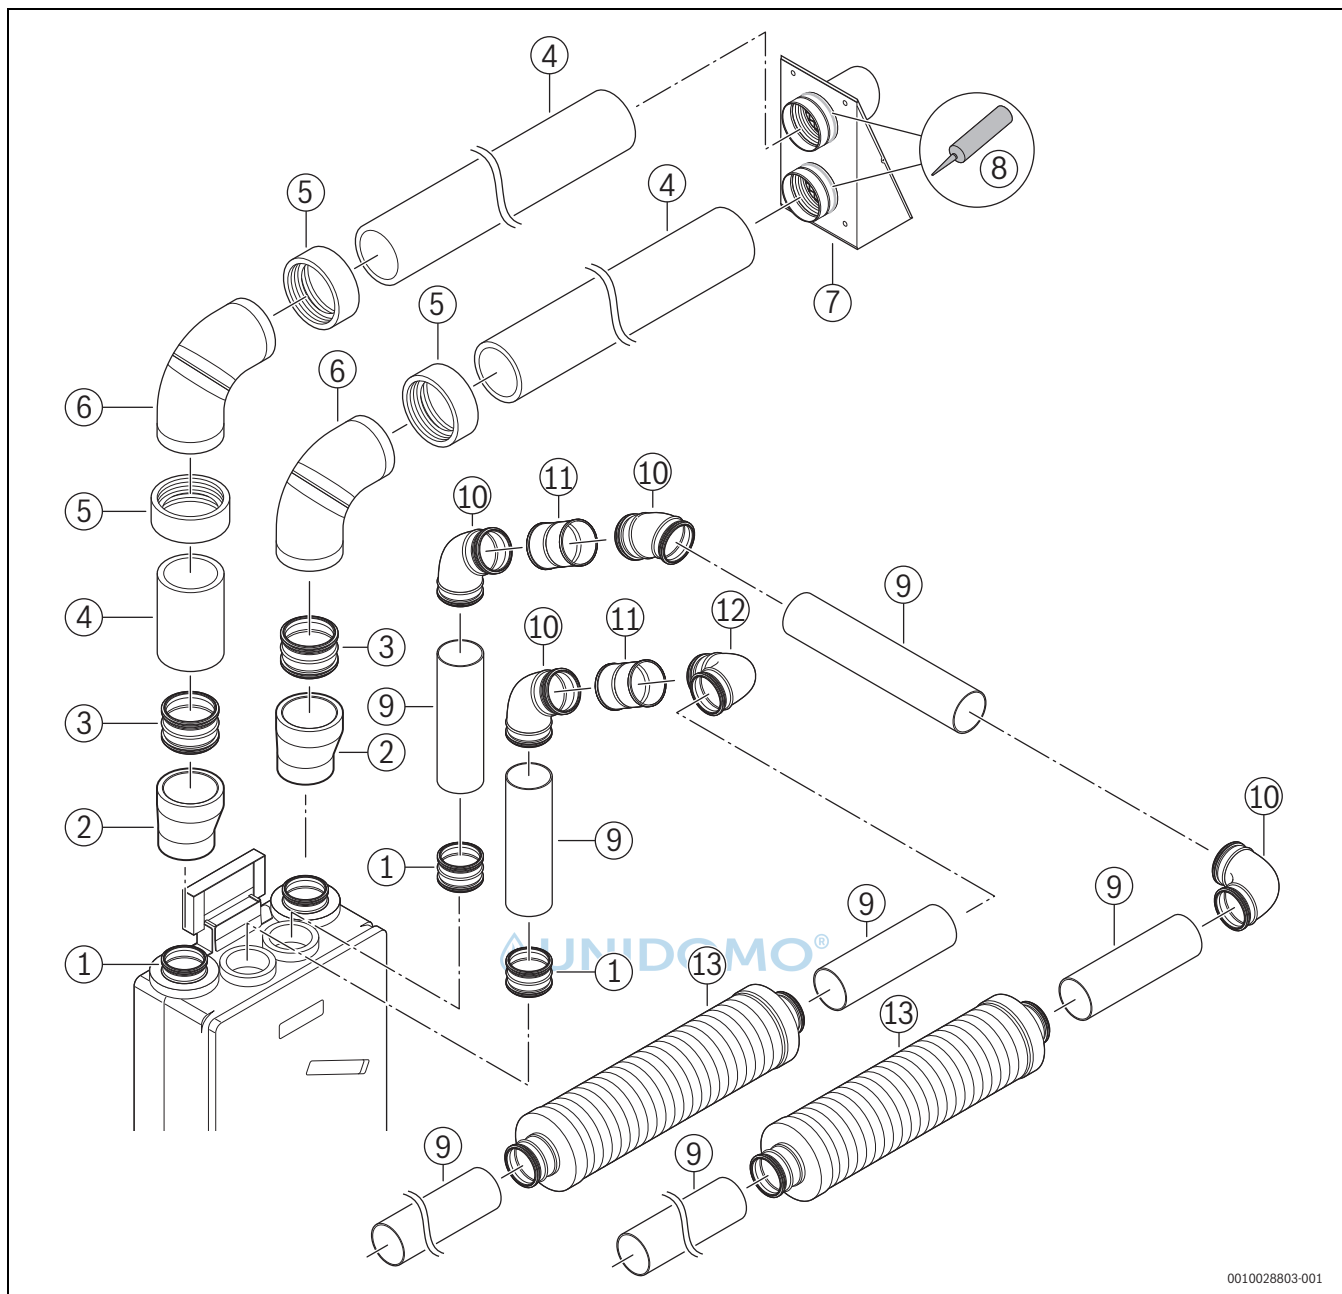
Anschlussdetails zu Bild 39: Rohrführung Zu-/Abluftleitung
